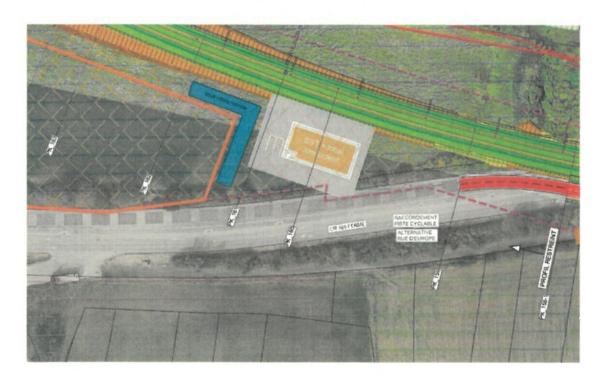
plan de localisation SST Bongertsfeld au PK 6400
